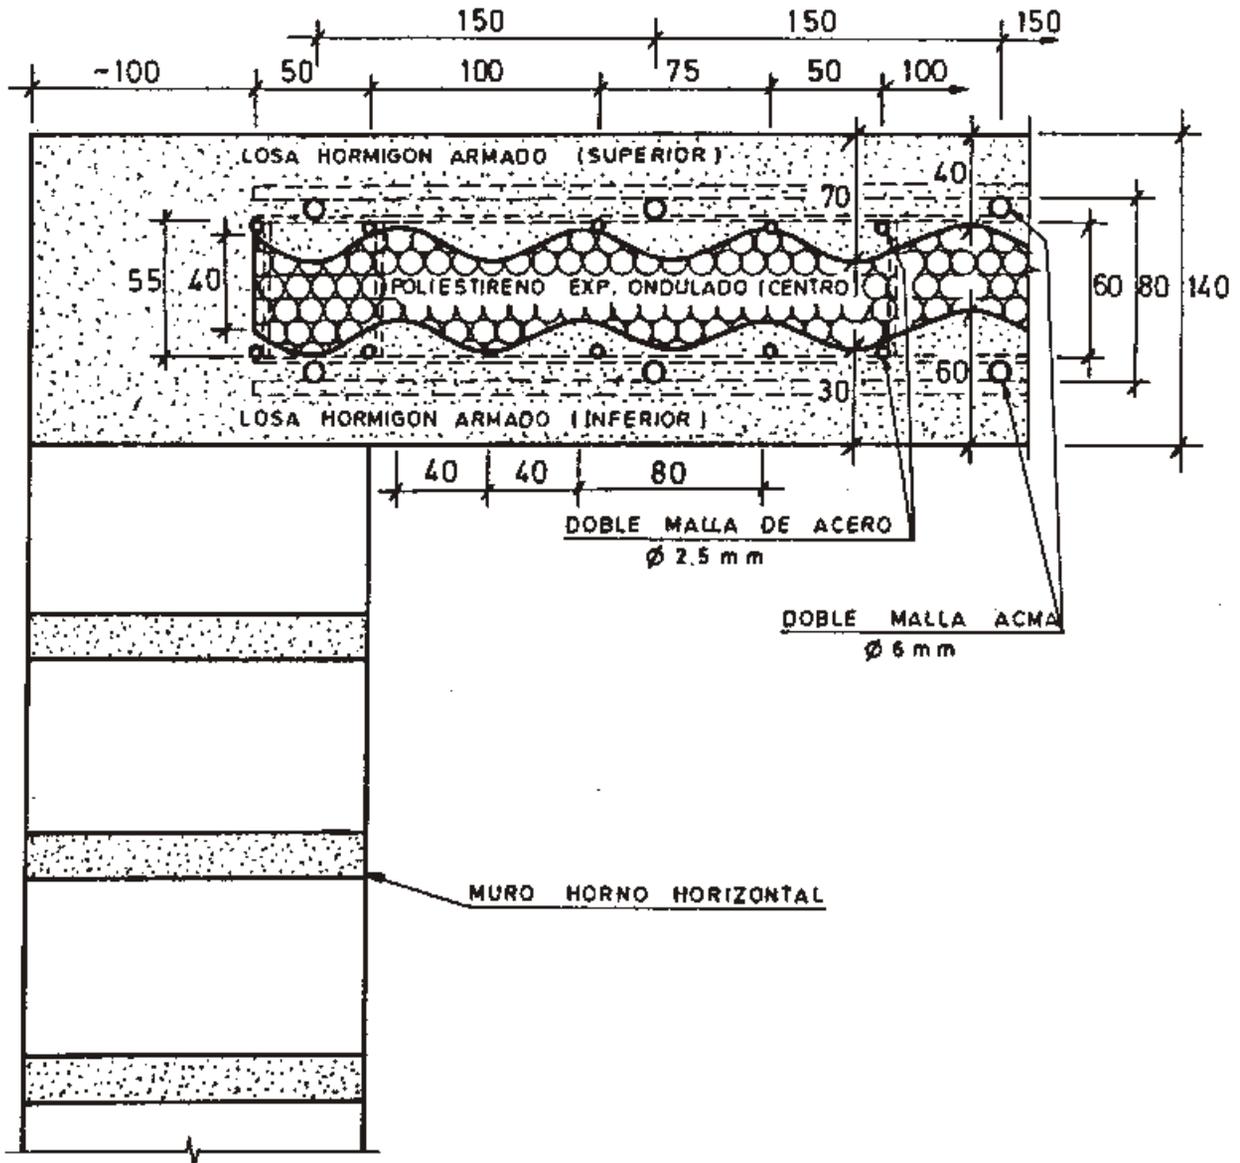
CORTE A-A EN DETALLE DE LA LOSA
